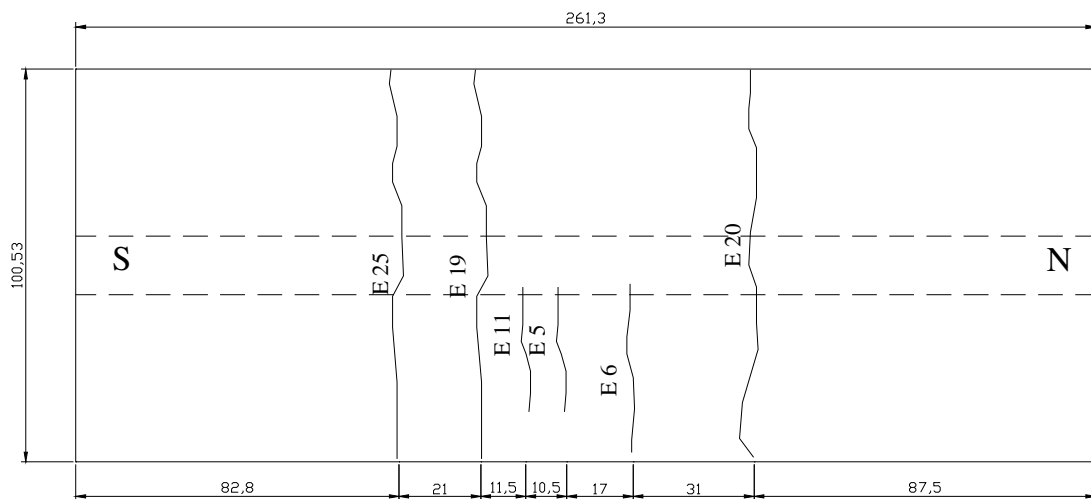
Fissuras do modelo 3A (face superior) – medidas em cm.
